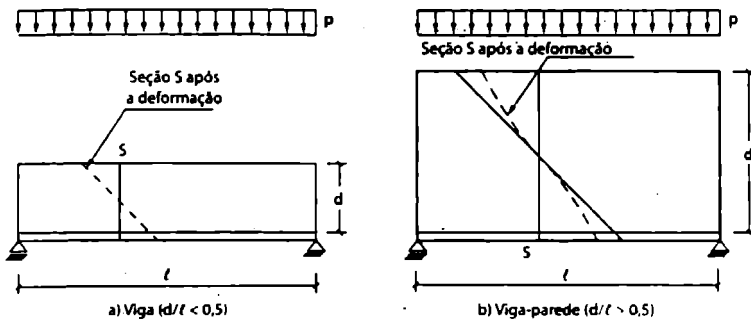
a) viga (a seção após a deformação permanece plana); b) viga parede (a seção sofre um empenamento após a deformação).
